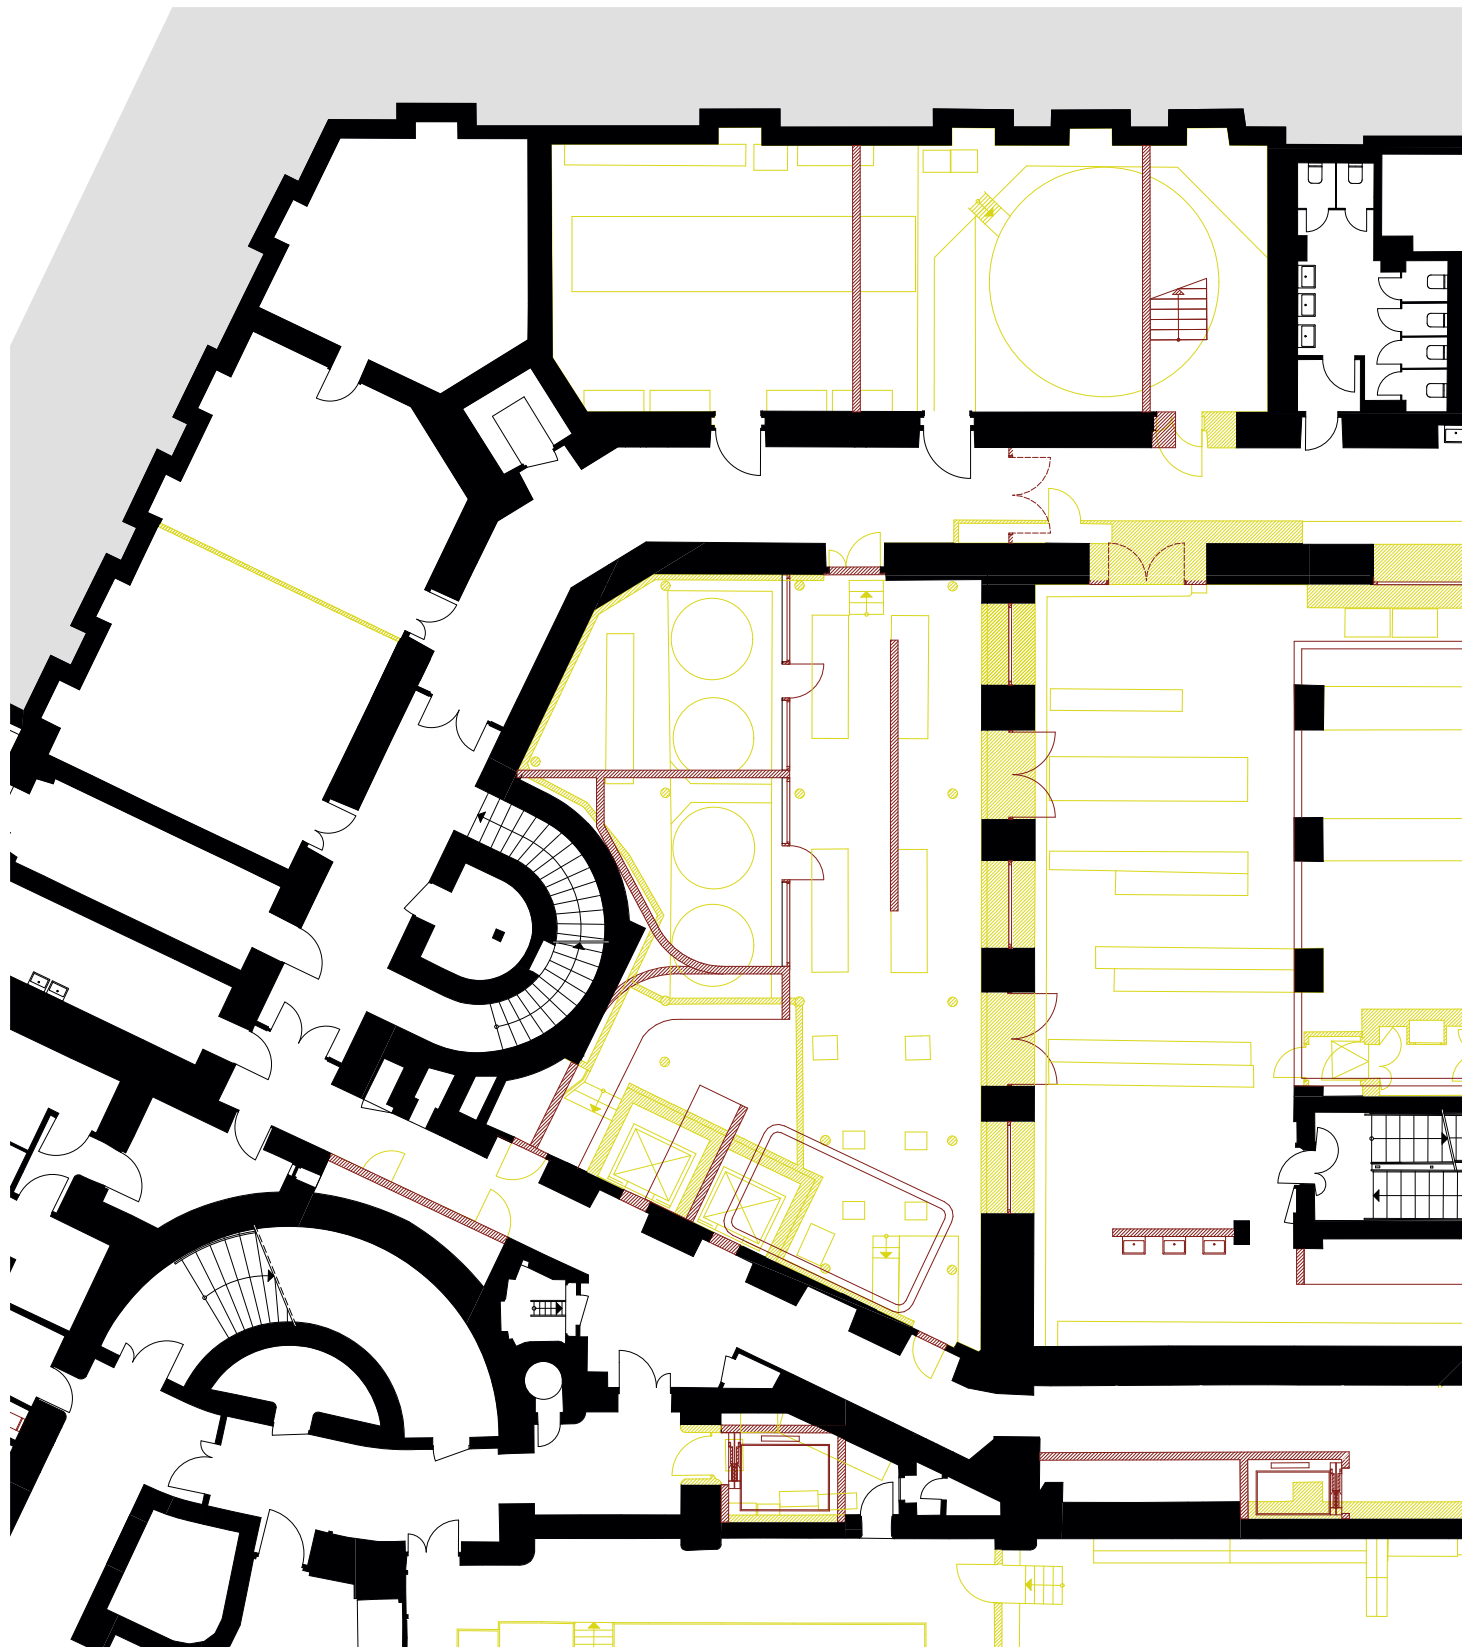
Entwurfsplan Grundriss Tiefparterre
